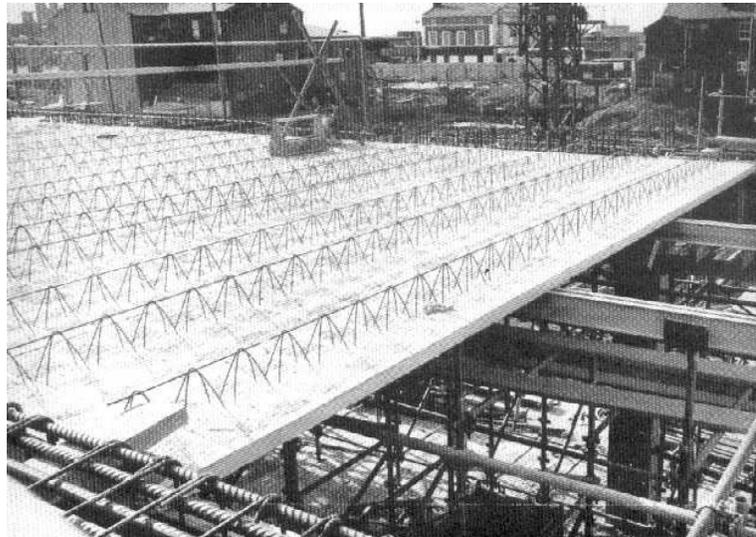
Pré-laje de concreto atuando como molde para a laje (CONCRETE SOCIETY, 1995).
